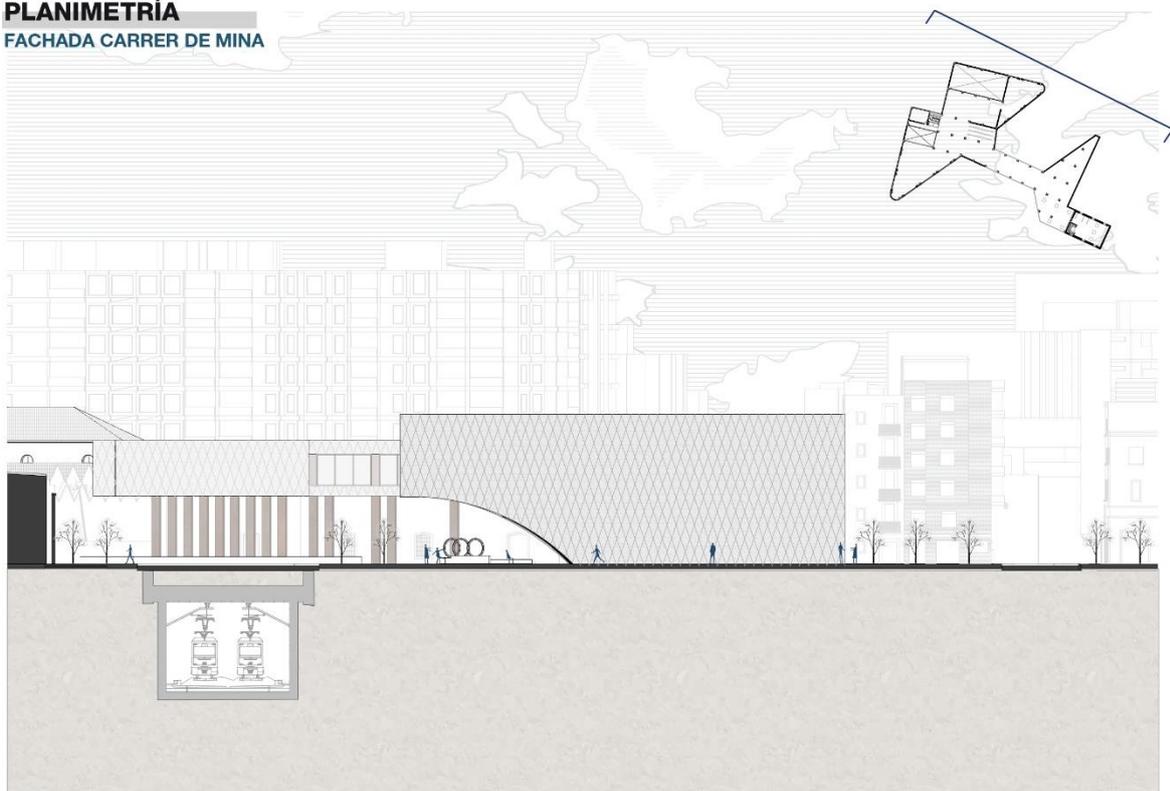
Fachada Carrer de Mina (Elaborado por: David Calderón)
